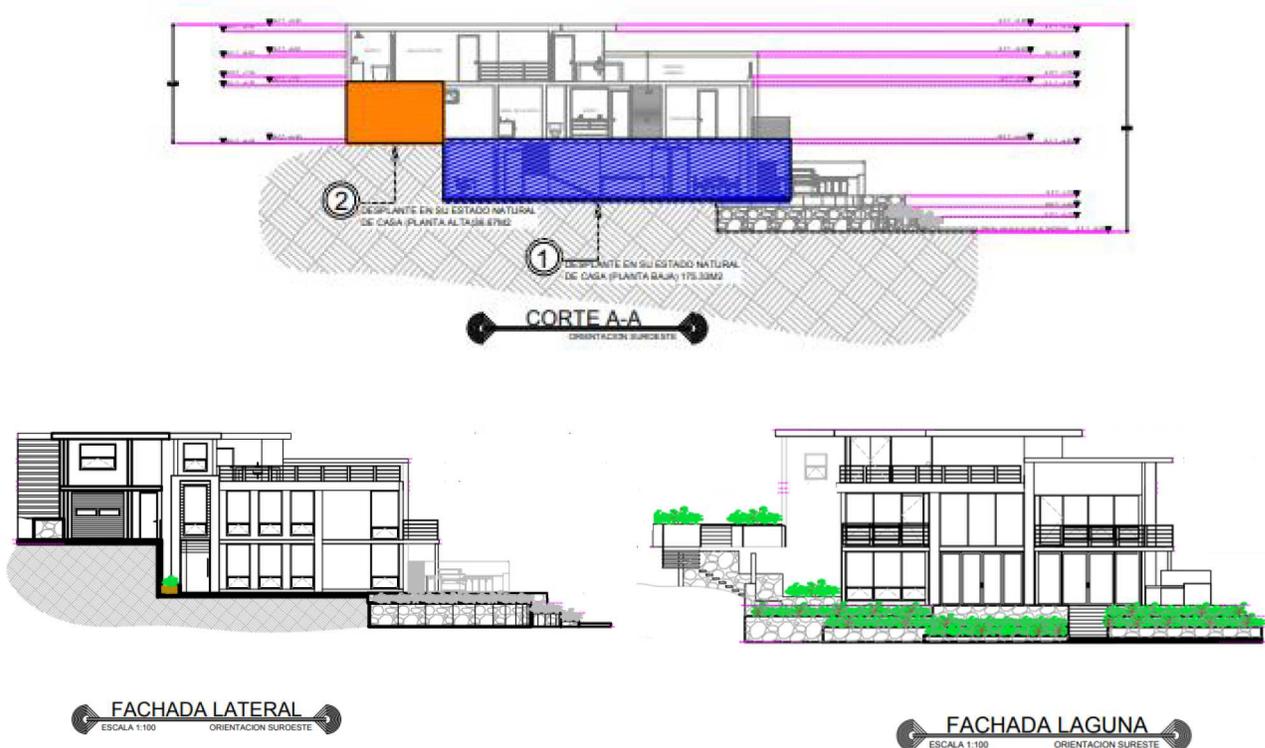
Planta arquitectónica y fachadas de la casa residencial.
